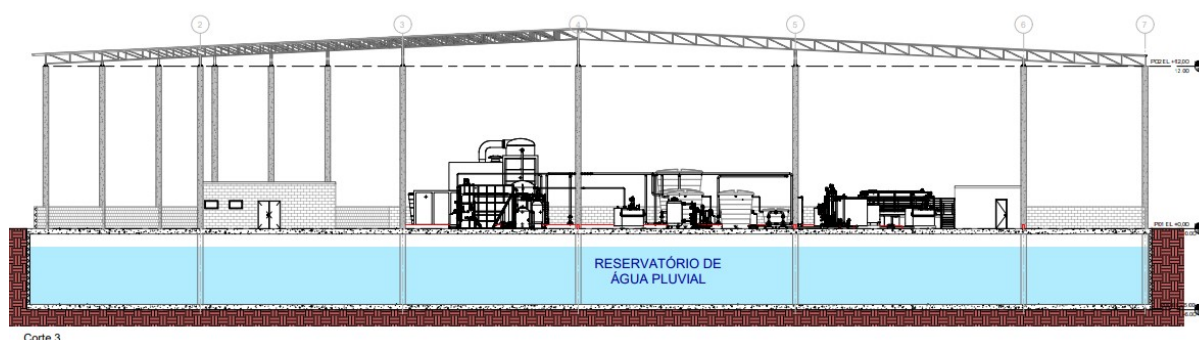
Localização da Planta de Tratamento de Água Pluvial e Planta de Reuso.
